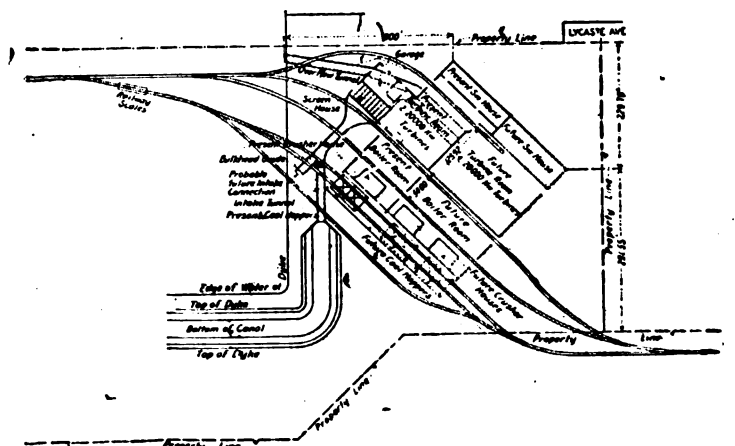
Pianta d'insieme della Centrale di Connors Creek.
